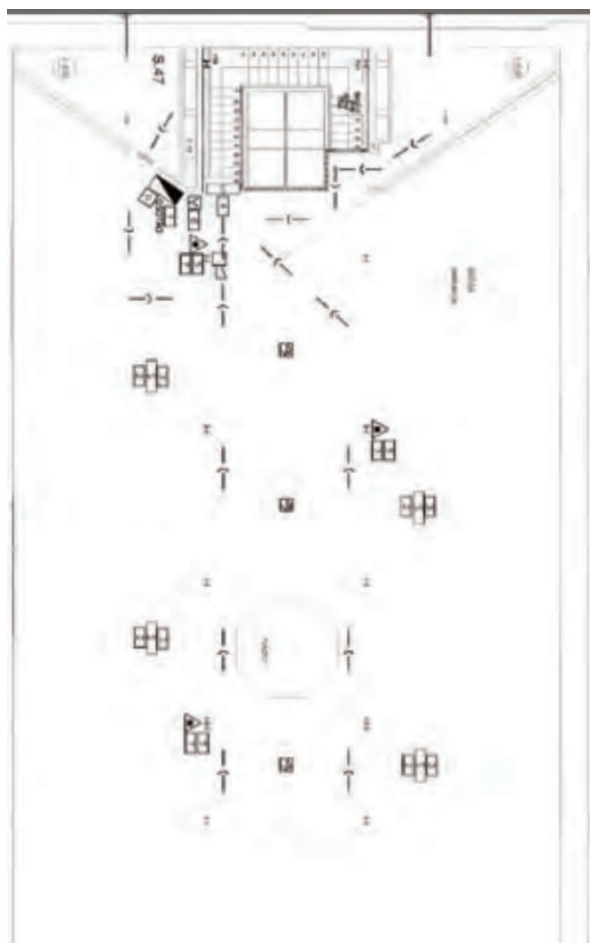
Plantas de prevenção - nível: piso 3 (sótão)
